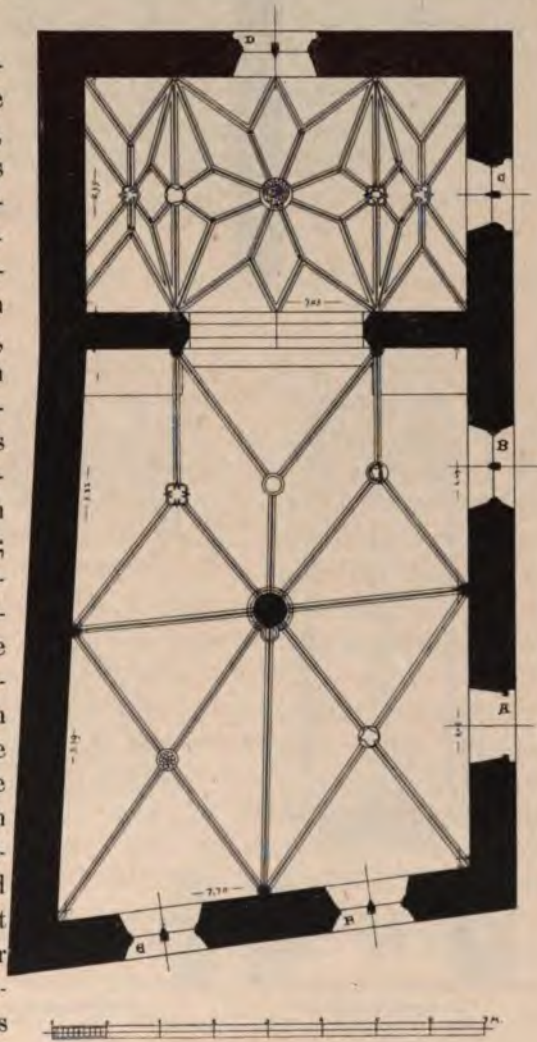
Kerpen. Grundriss der Schlosskirche.
